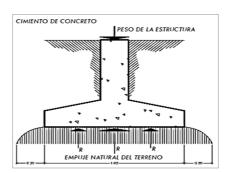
Cimiento de Concreto Armado Fuente: Investigación
